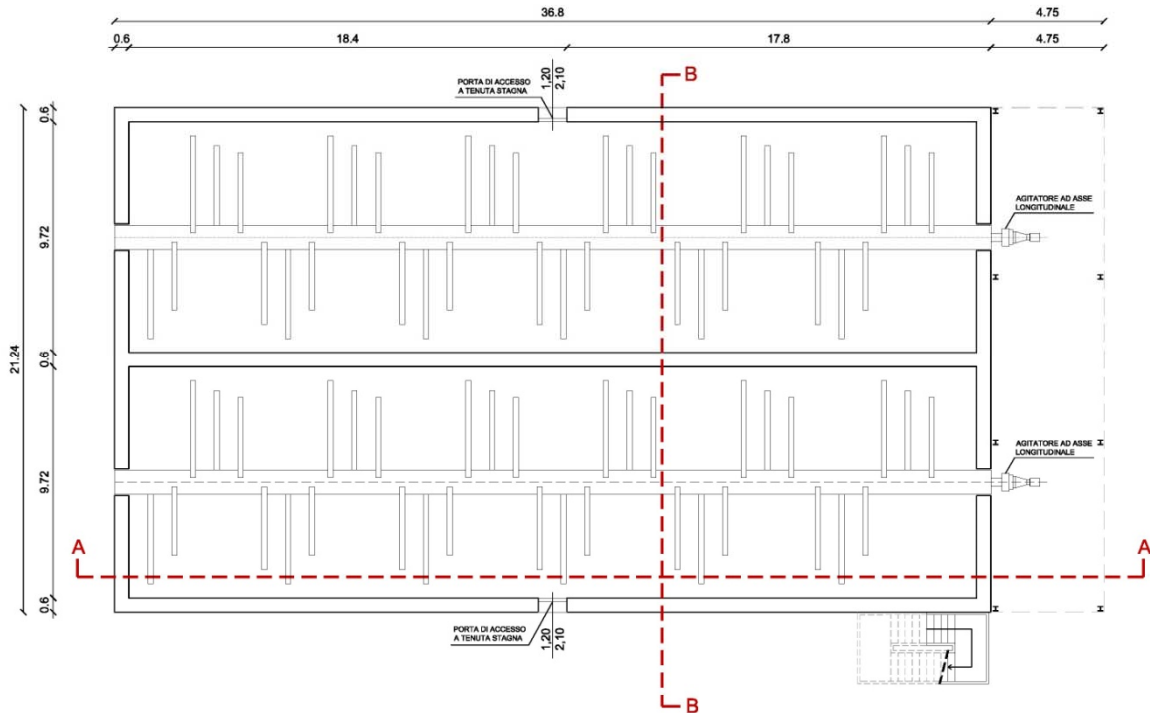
Pianta digestore primario – pianta a quota +1,20m
